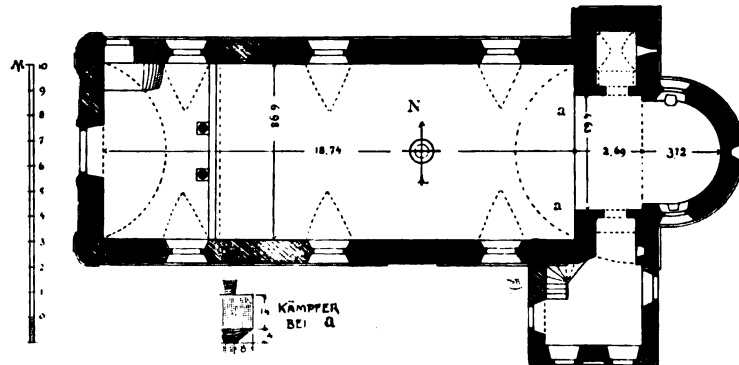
Oberfraundorf. Grundriß der Pfarrkirche.
